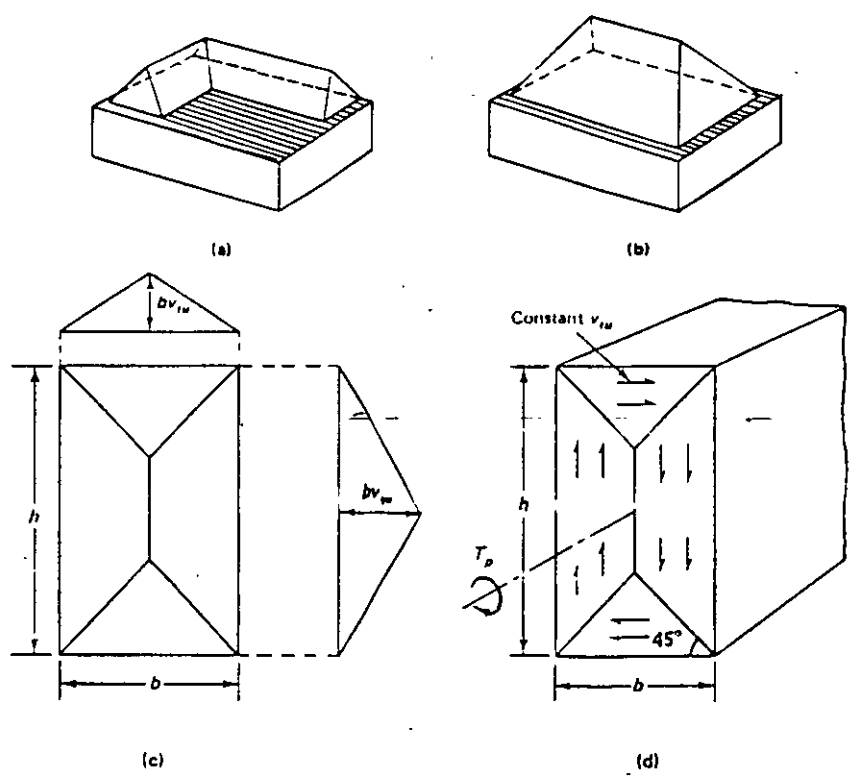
Analogía con el montón de arena en torsión plástica pura. (a) Sección en L del montón de arena; (b) Sección rectangular del montón de arena; (c) Planta de la sección rectangular; (d) Esfuerzo cortante torsional
